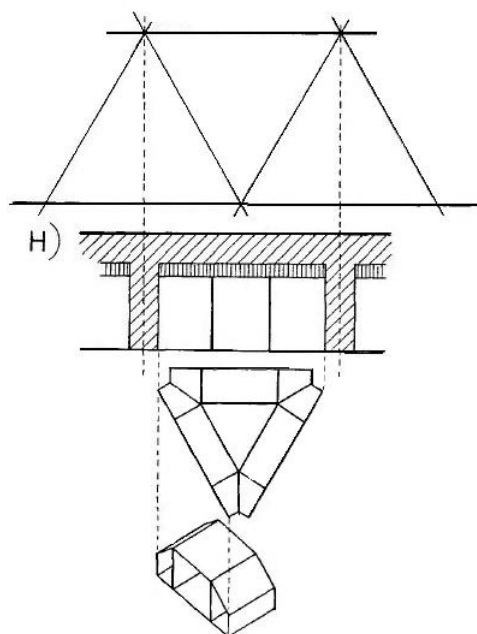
Solución elaborada por extrusión combinada con una pieza prefabricada de cierre
